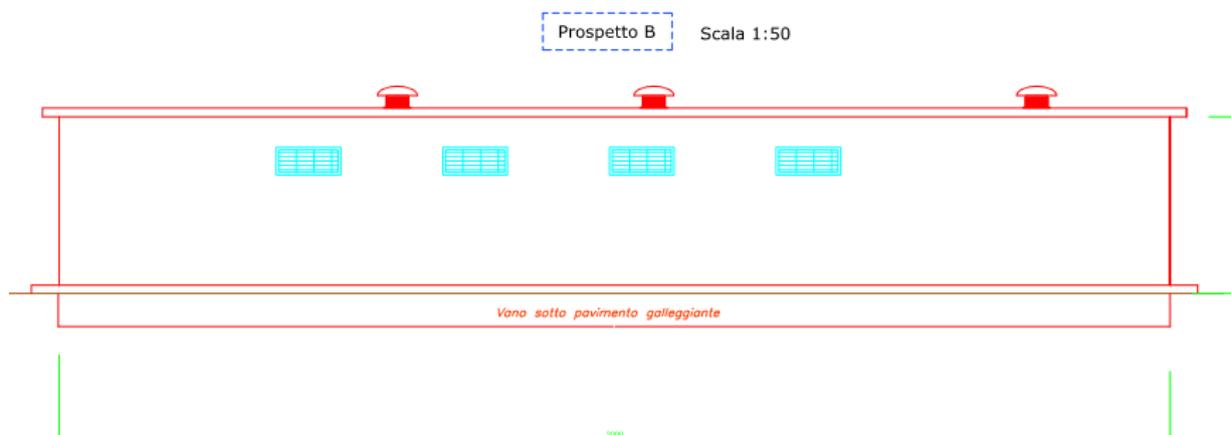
Prospetto lato strada della cabina di consegna dell'Area Nord di Impianto
